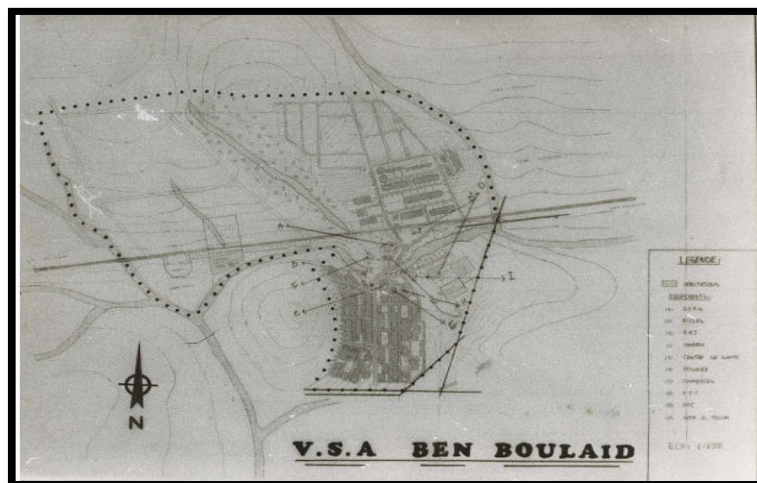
Plan de masse du village Ben Boulaïd¹²¹
